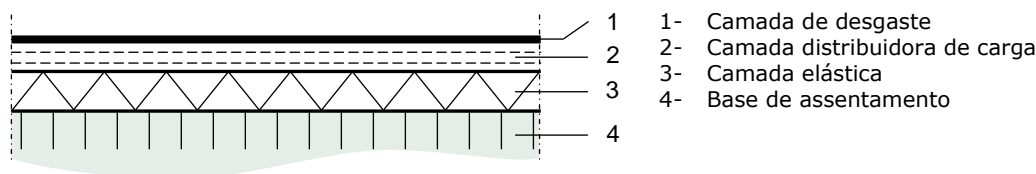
Esquema tipo de pavimento desportivo multi-funcional de interior
